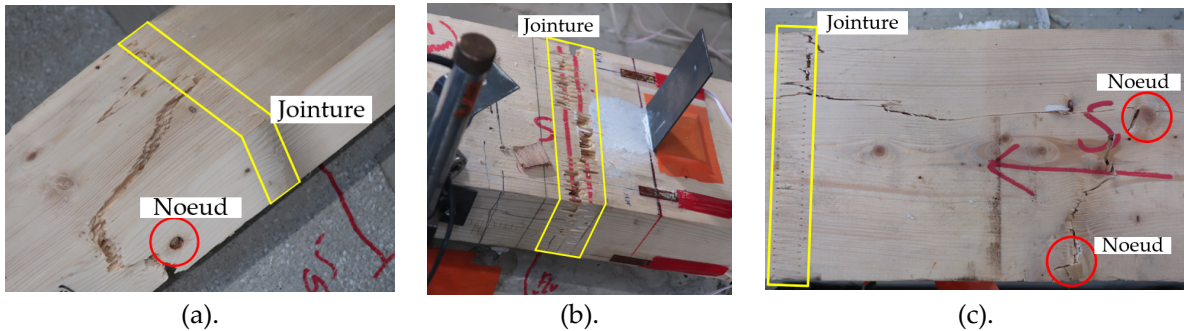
Mode de ruine des essais de flexion. (a) Essai F1, (b) Essai F2, (c) Essai F3.
